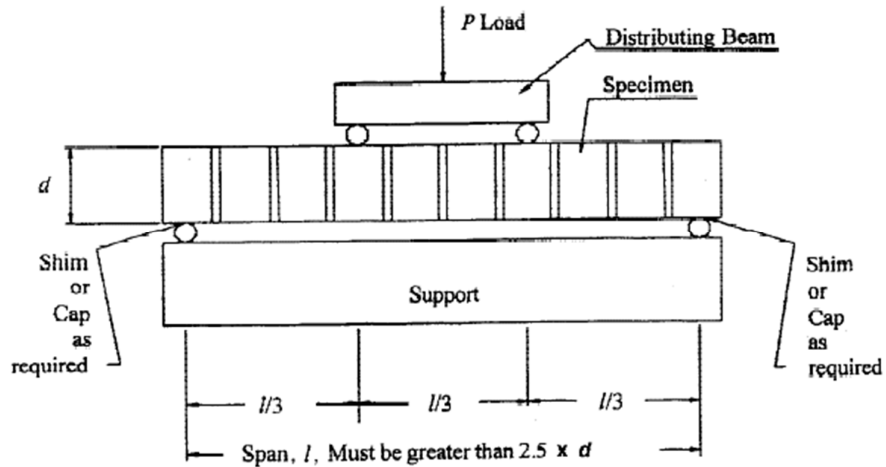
Ensayo a flexión por adherencia de un muro de albañilería ⁽³³⁾
